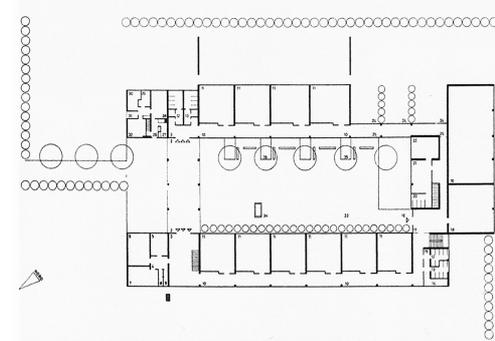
| Grundriss Volksschule Nüziders
